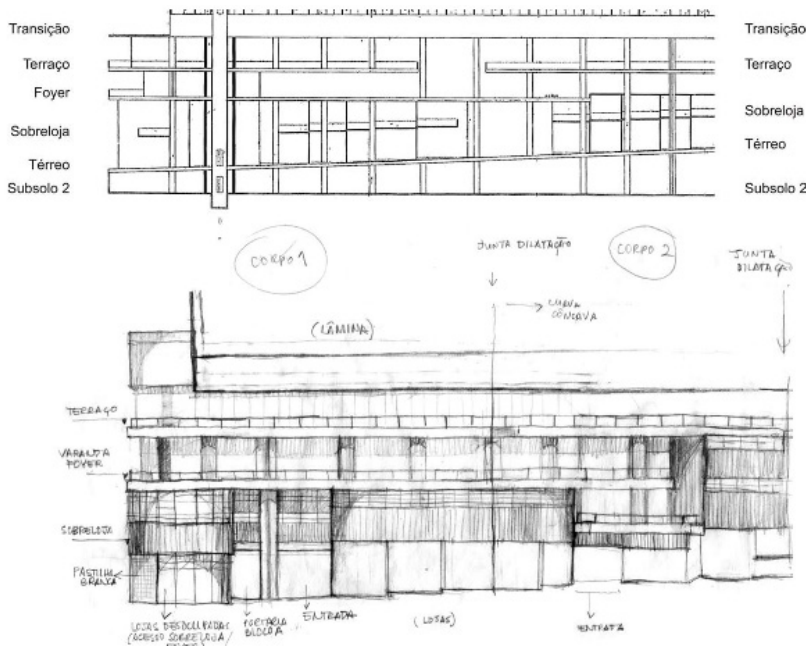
Trecho de corte longitudinal, en contrapunto al dibujo de observación de la Fachada Norte de la base, dirigida para la Calle Unai
